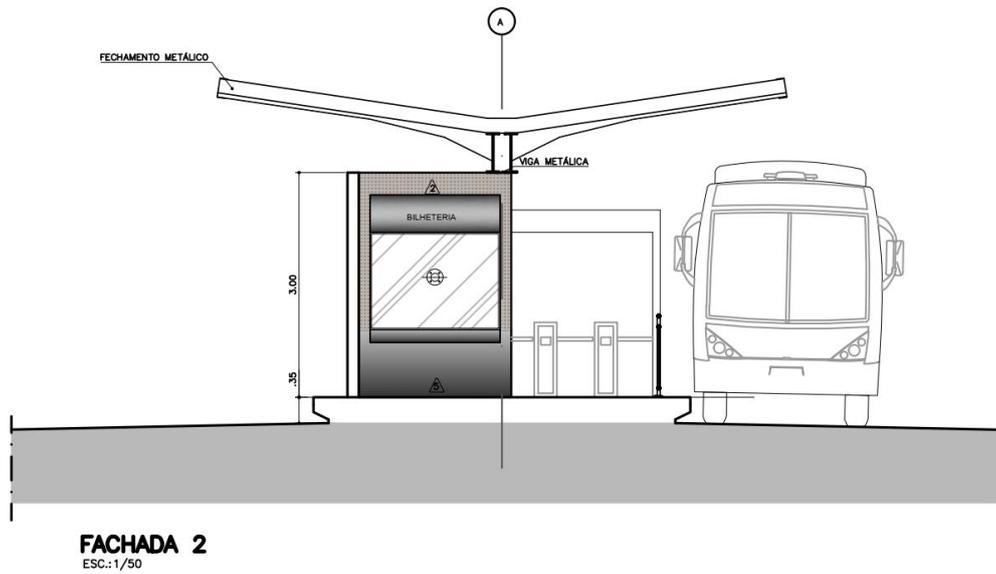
Corte em perfil da Estação 4 do BRT Sudoeste
